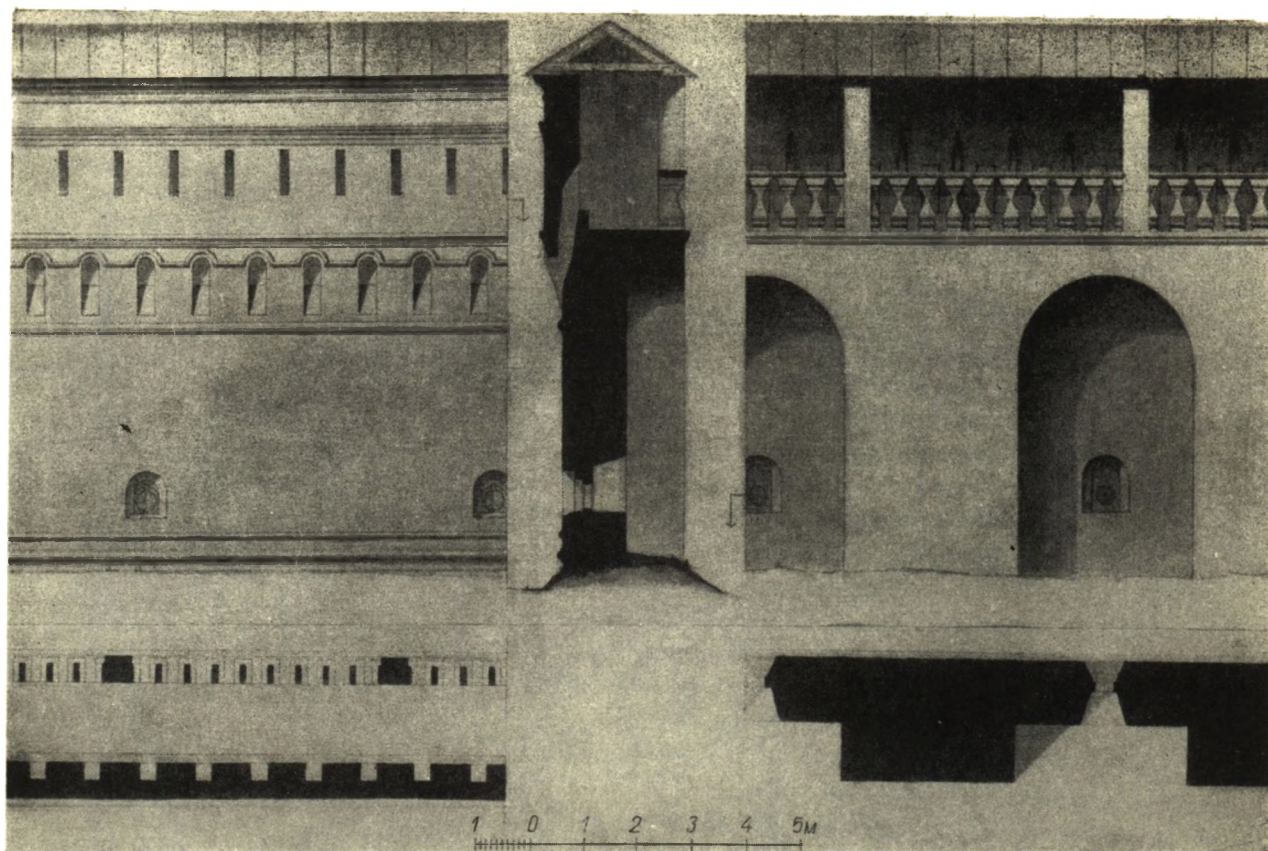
Воскресенский монастырь. План, фасады и разрез стены
